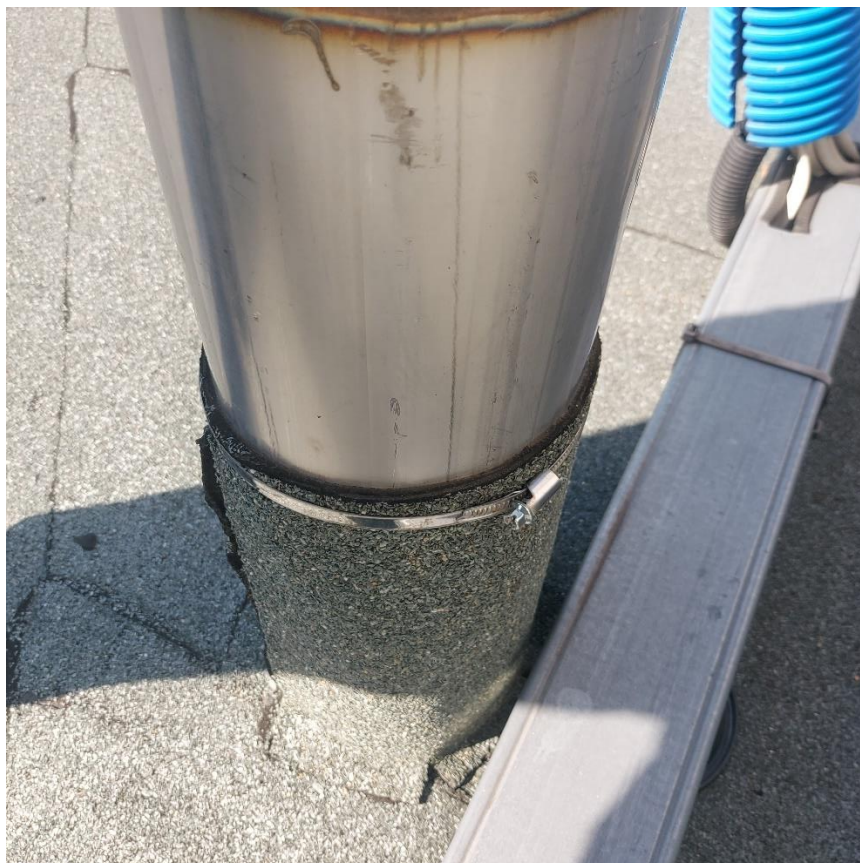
Braki uszczelnień przebić konstrukcji stalowej przez dach
